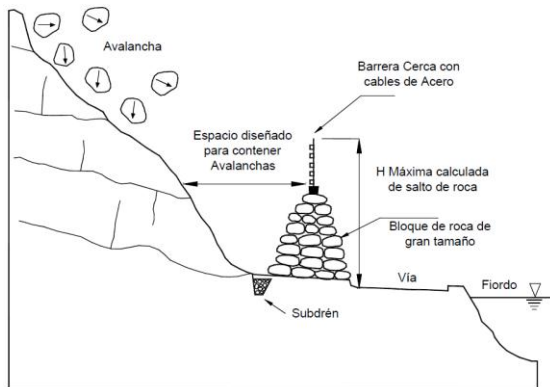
Muros alcancía en roca para control de avalanchas utilizadas en Noruega.
